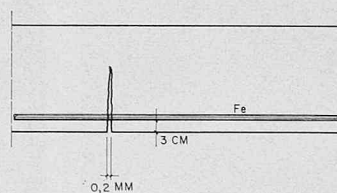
Vergleich der Rissbildung Eisenbeton / Betongelenk
